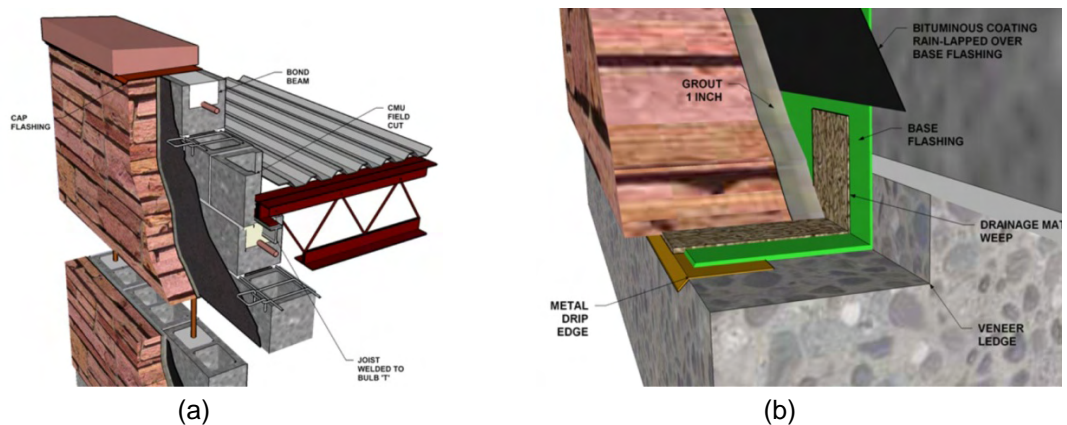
Sistema *Barrier Wall/Stone Veneer Reinforced Concrete Block*.
